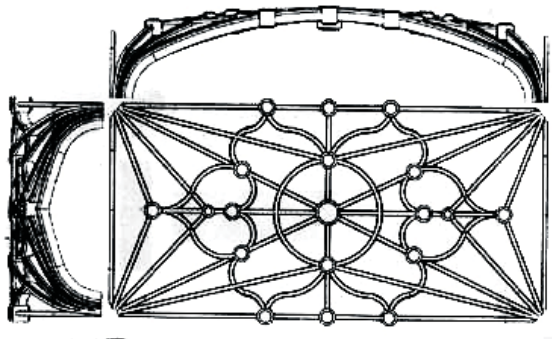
Planta y secciones de la bóveda del sotocoro del convento de San Esteban mostrando su sección longitudinal y transversal curvada e inclinada hacia el formero (Fuente: J.C. Palacios).
